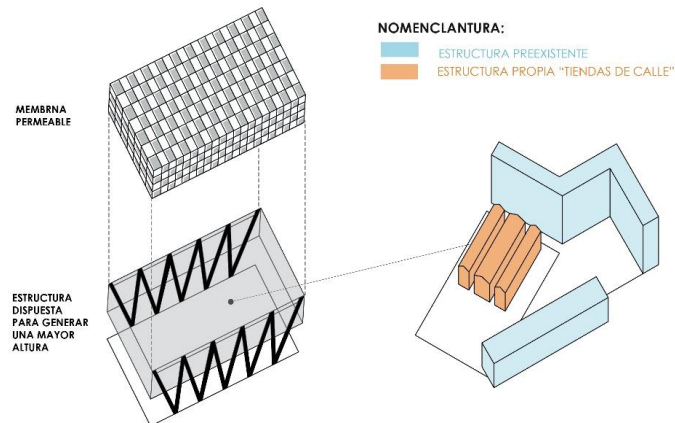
Diagrama de Soporte estructural. Mercado Villa Nova Famalicao.
